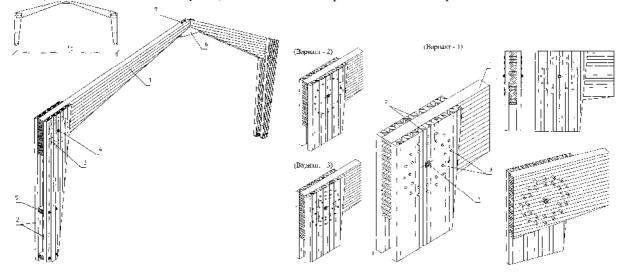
Рама на нагелях по кругу в карнизном узле: а) общий вид; б) варианты карнизных узлов: 1 – ригель рамы; 2 – стойка рамы; 3 – нагели, расставленные по окружностям; 4 – монтажный болт с квадратной шайбой; 5 – деревянная прокладка; 6 – деревянная накладка; 7 – стяжные болты
